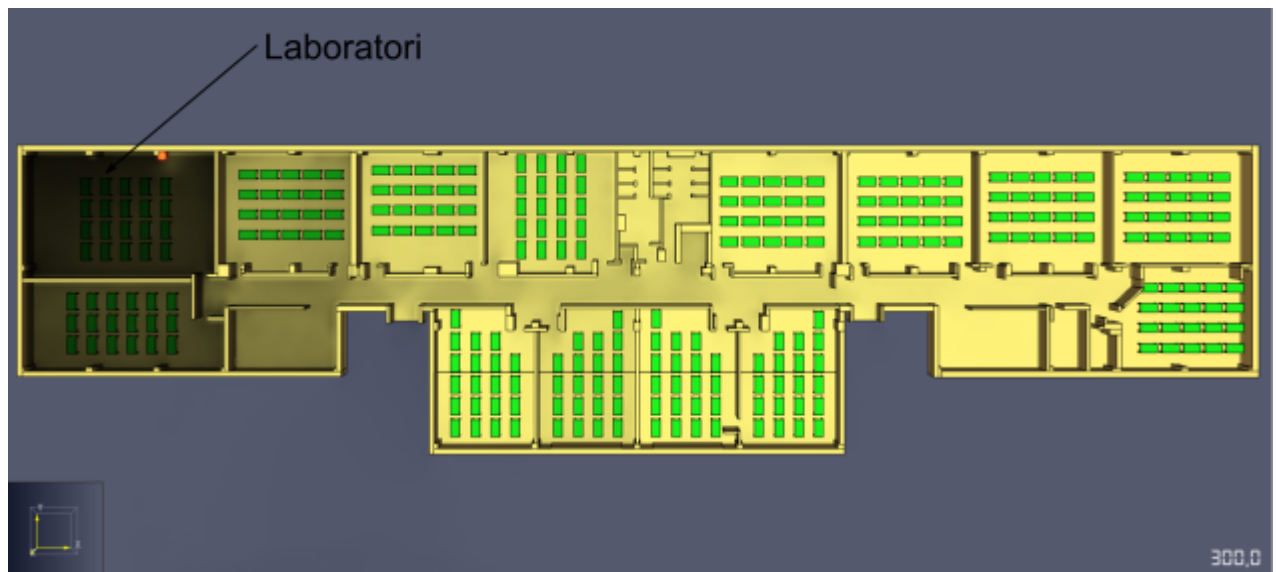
Vista de la planta 2 passats 300 segons des que comença el foc.
